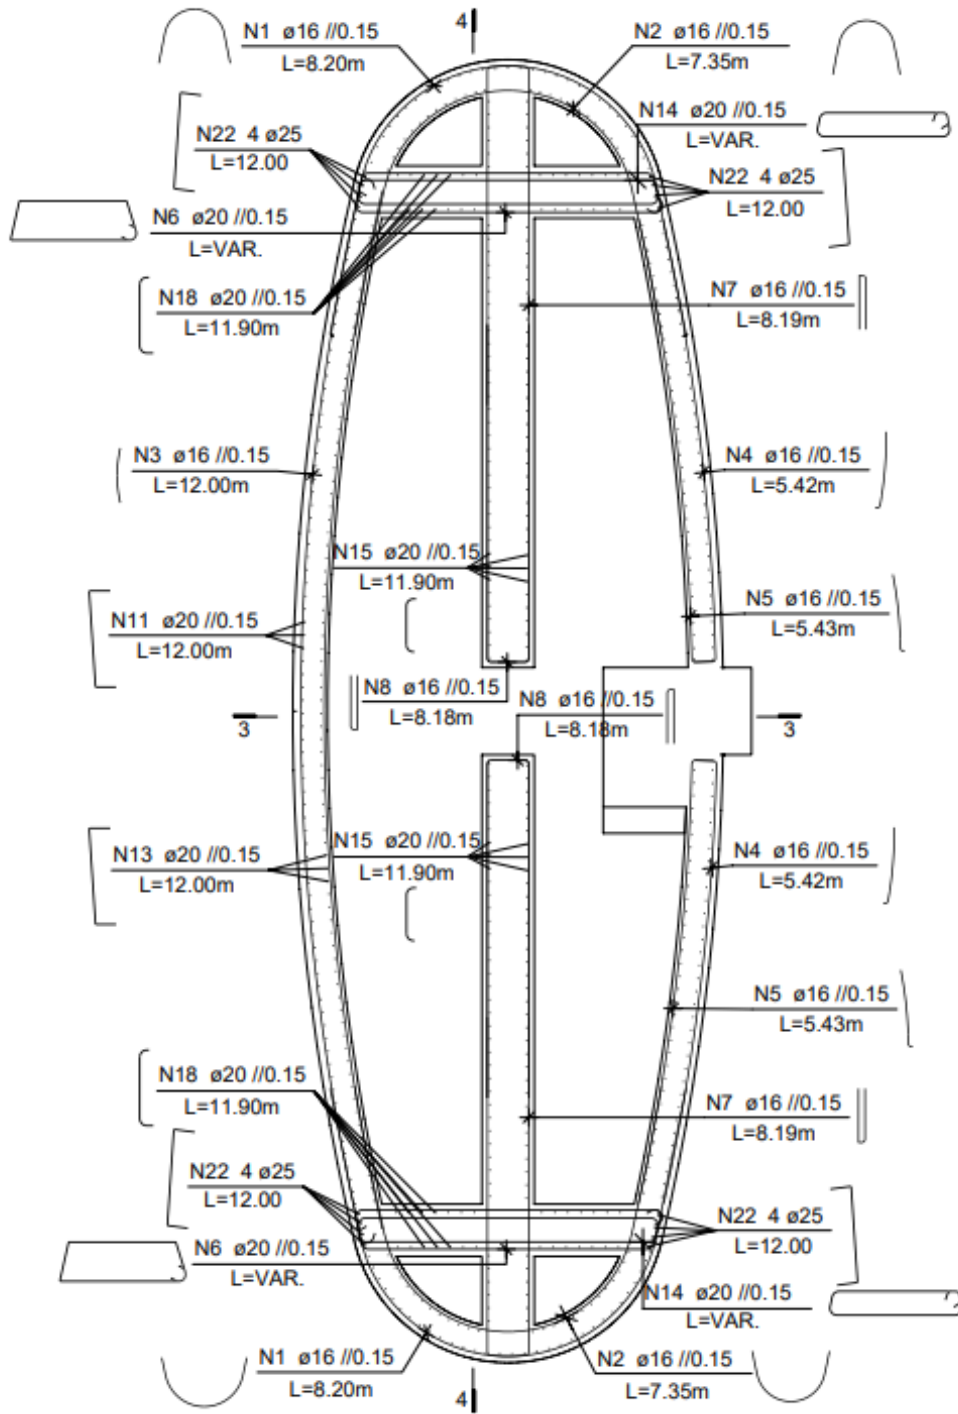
Corte em planta das armaduras do pilar PC1 com etiquetas associadas
